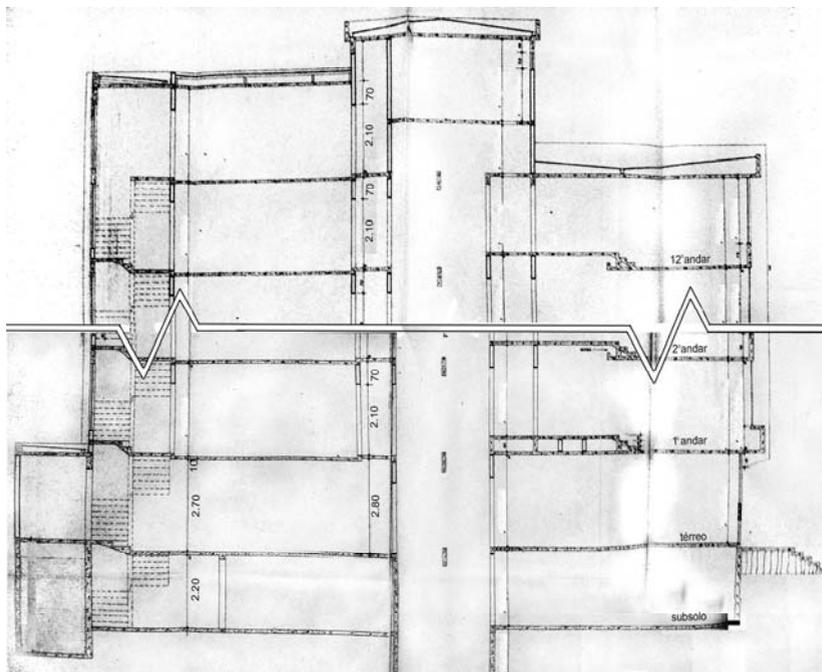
Corte longitudinal do edifício Aldebarã com doze pavimentos
